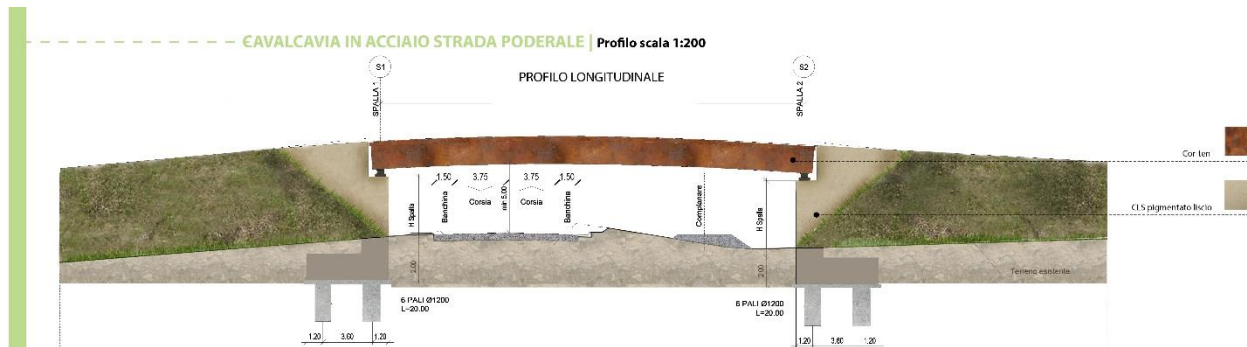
prospetto tipico di cavalcavia su viabilità secondaria
